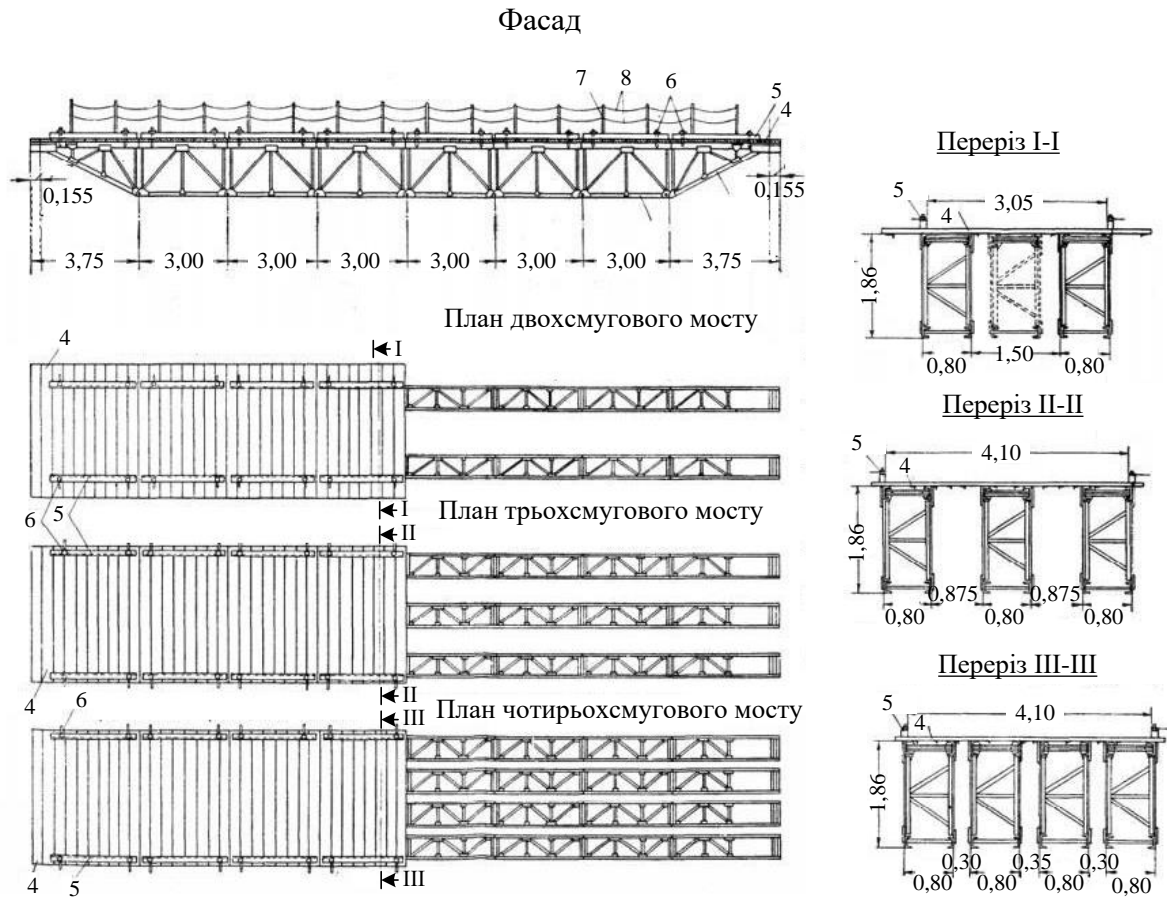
Збірні схеми прогонової будови: 1 – проміжні секції ферми; 2 – кінцеві секції ферми; 3 – вузловий штир; 4 – щит для настилу; 5 – колесовідбійник; 6 – пажильний болт; 7 – перильна стійка; 8 – перильний канат
